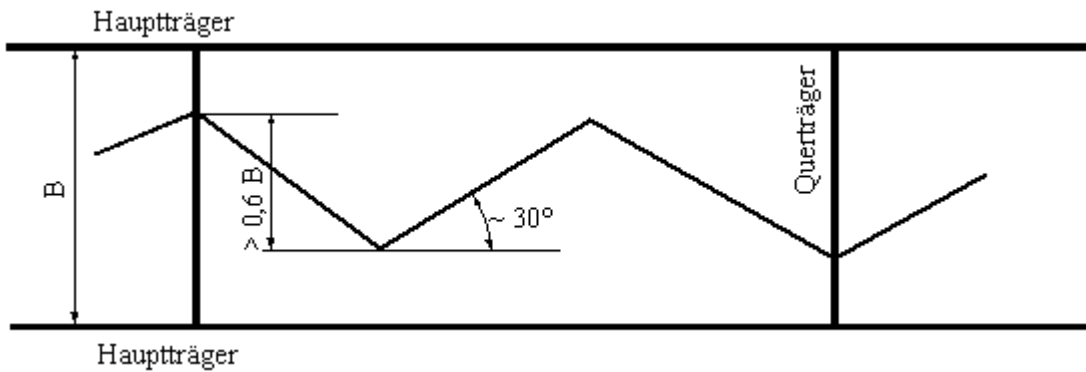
Grundriss einer Brücke (schematisch) mit vertikalen Einbauten (z.B. Drahtgewebe)
